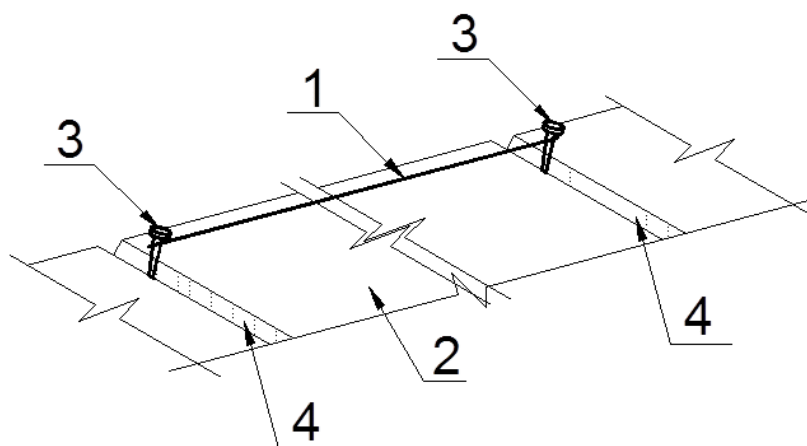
Устройство причального шнура. 1 - причальный шнур, 2 – плита перекрытия, 3 – гвозди; 4 – шов между плитами перекрытий.
